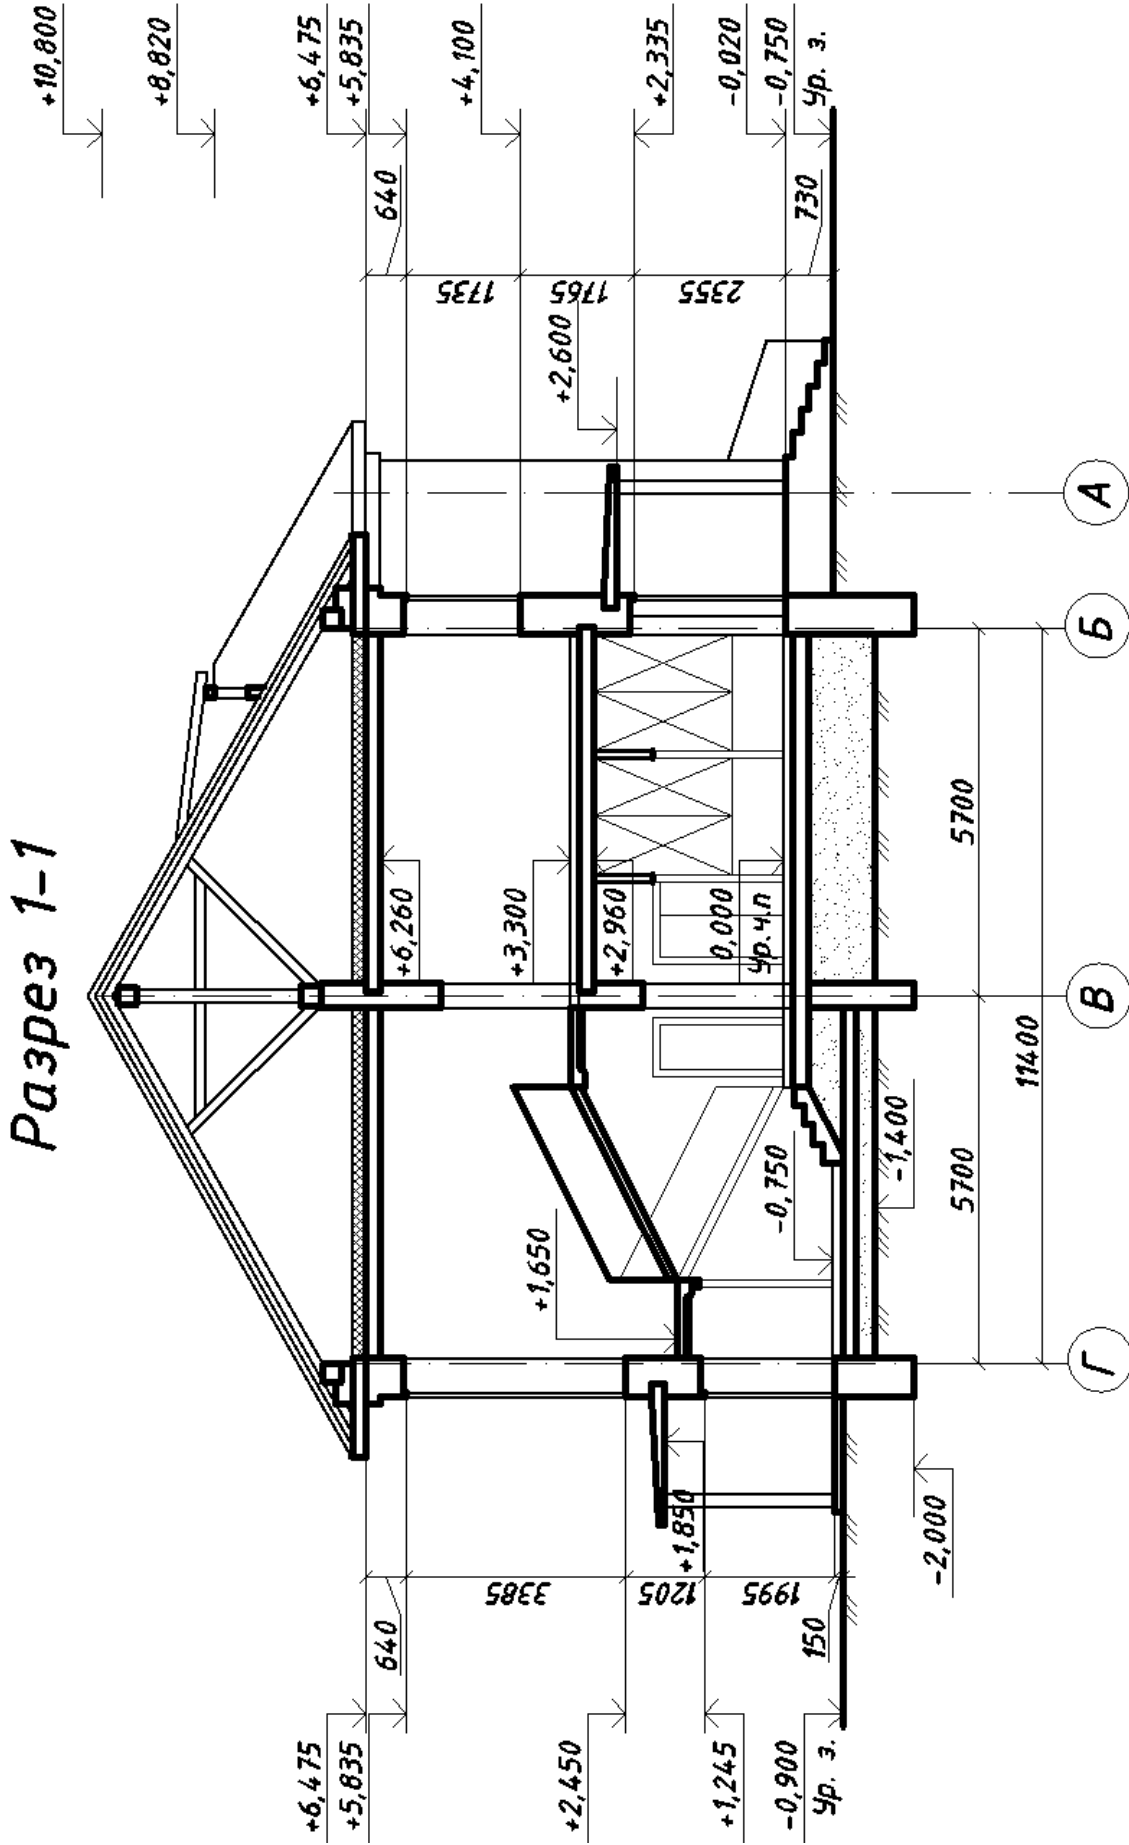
Пример выполнения разреза здания со стропильной кровлей в масштабе 1:100
